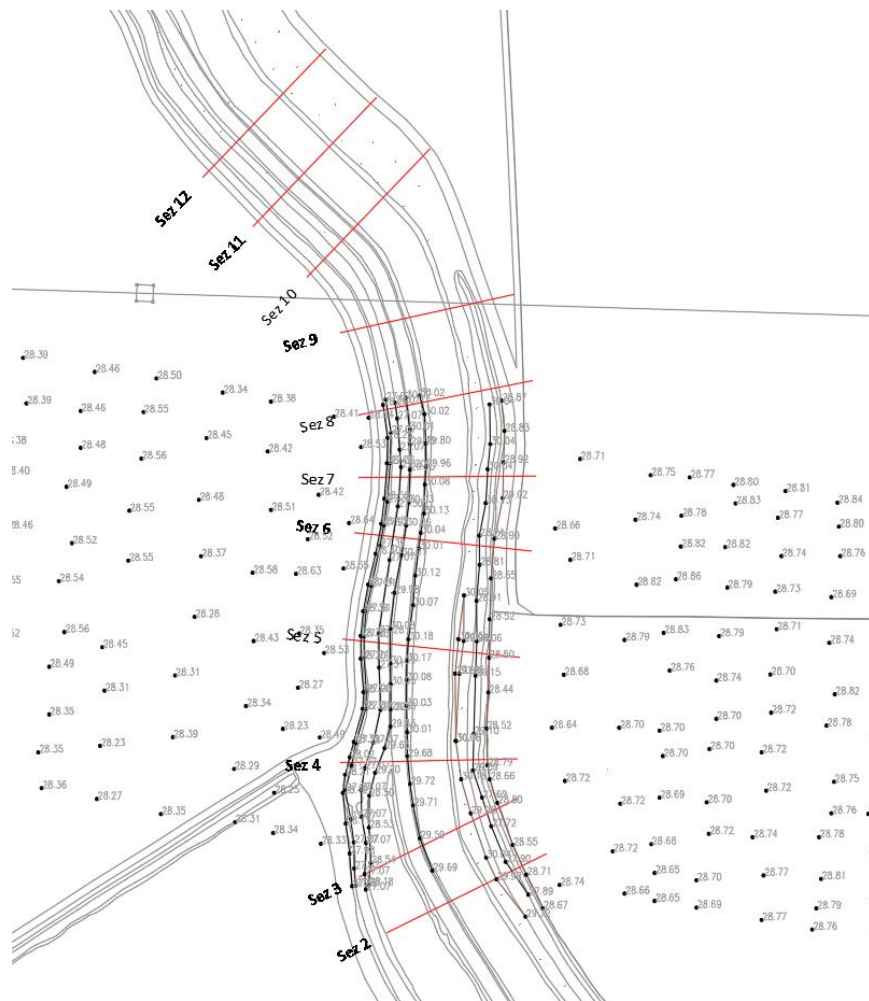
Torrente Fibbio – Stralcio planimetrico stato di fatto con l'indicazione delle sezioni.
